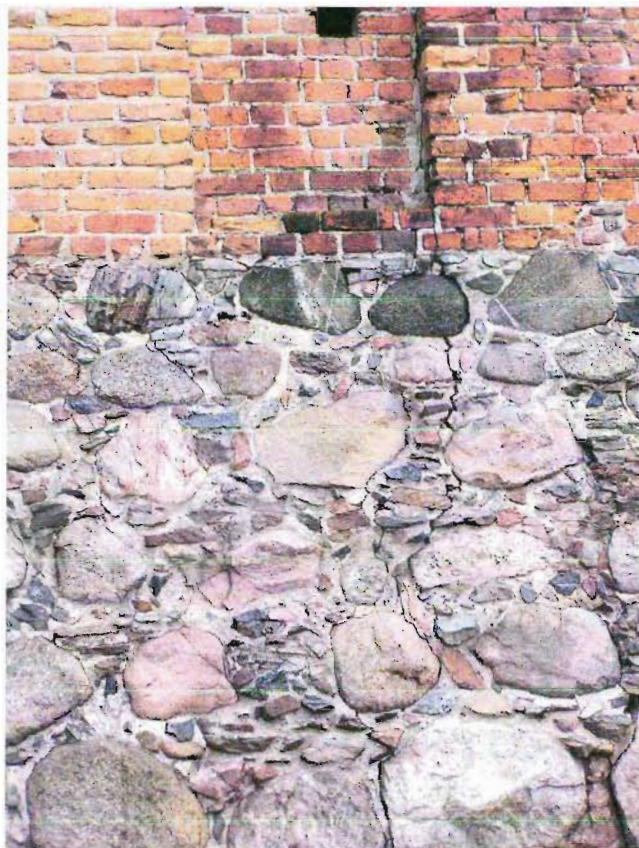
Widoki od zach. -fragmentów pld. części muru zachodniego z przyporami,
